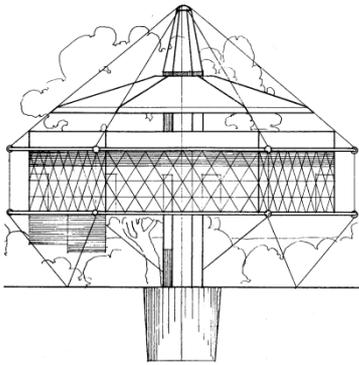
Alçado e planta da 'Dymaxion house', RBF, 1927.
